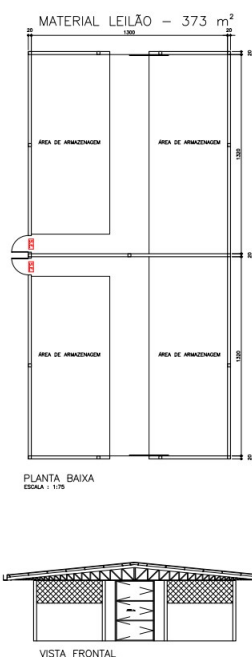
Planta baixa e vista frontal do galpão de material de leilão. - Fonte: RCA.
